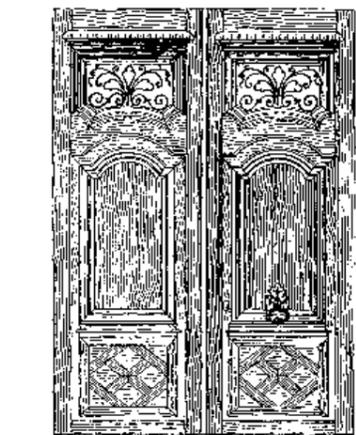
Carpintería de madera maciza. Tratado práctico de edificación. E.Barberot
